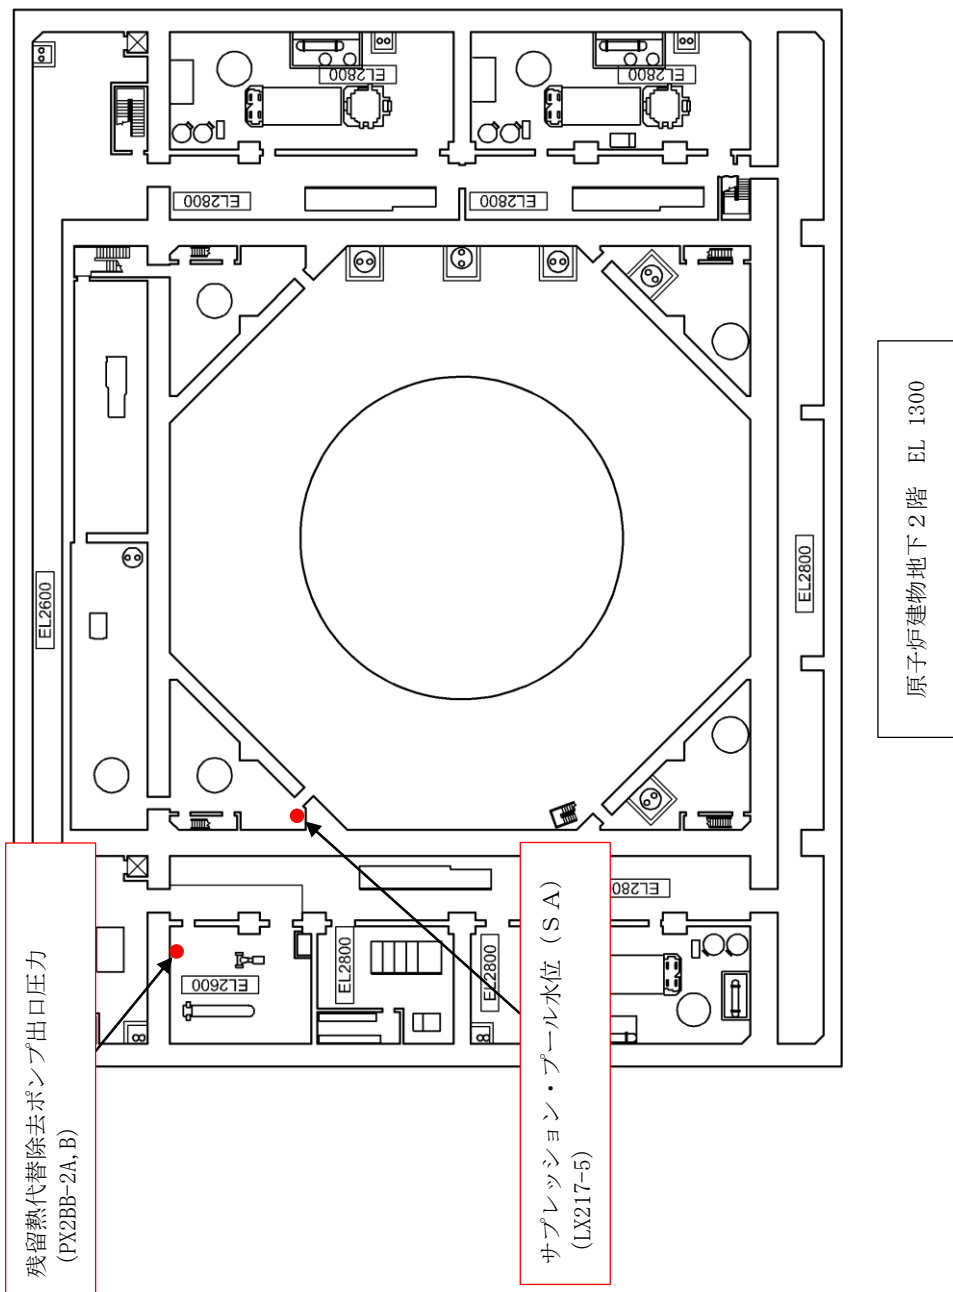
機器配置図 (原子炉建物地下2階)
